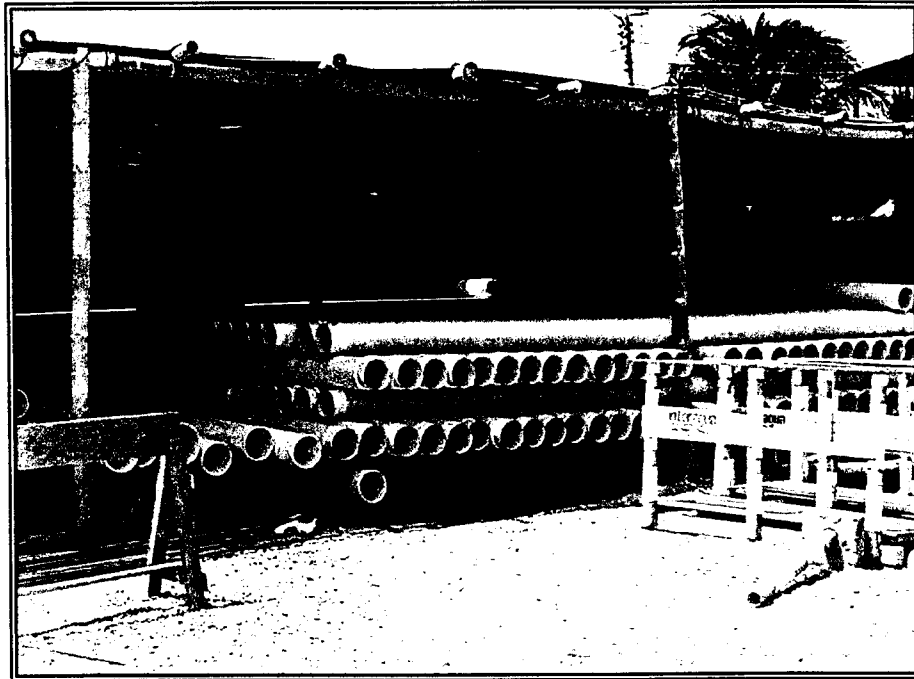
Campamento de Ecuaconstrucciones. Ejecución de cámaras AA SS.
